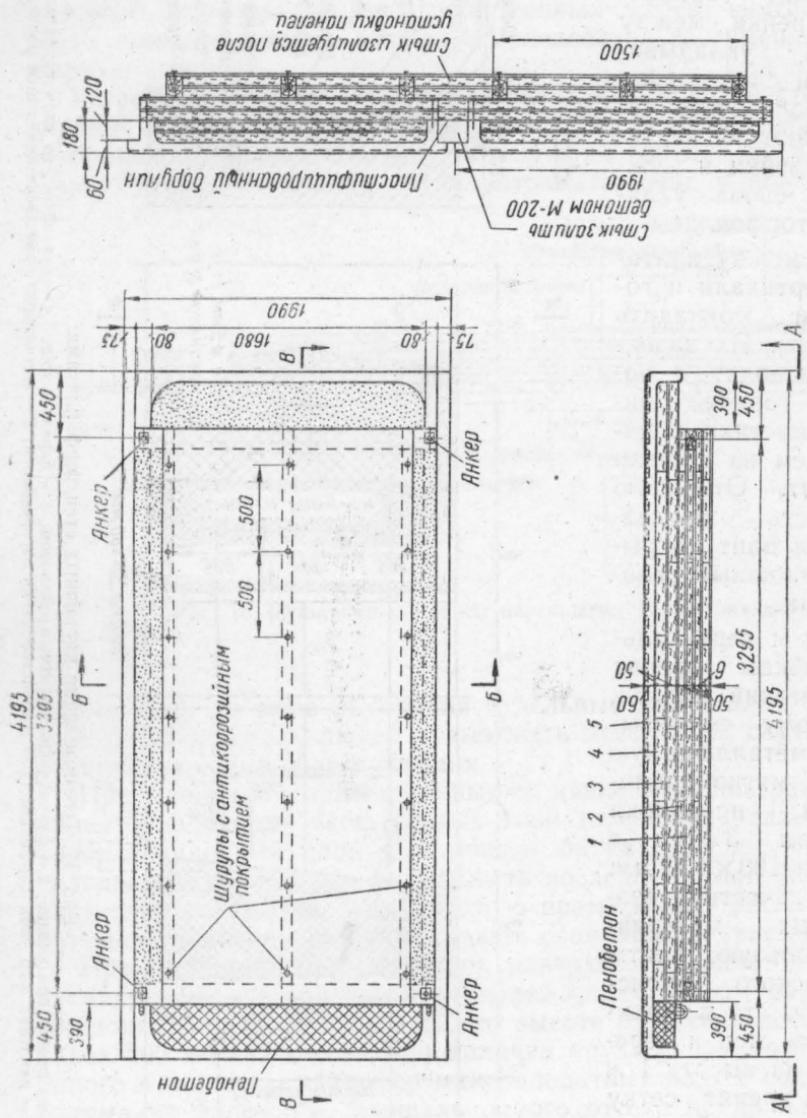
Изоляция сборный железобетонной стеновой панели минераловатными плитами:
